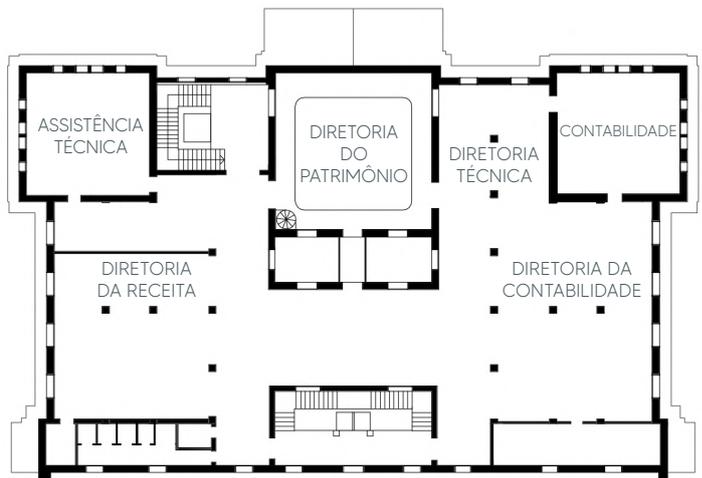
Redesenho planta do 3º andar, Secretaria da Fazenda, 1942.
